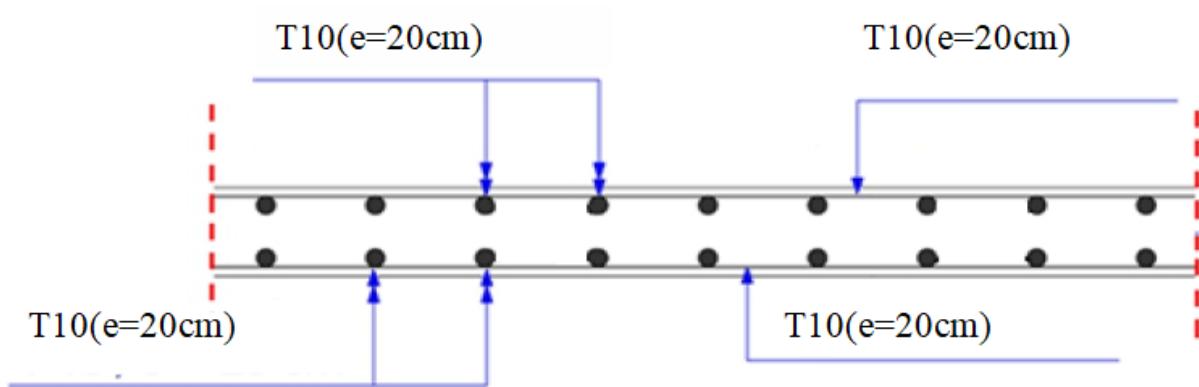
Dessin de ferrailage de la dalle pleine.
